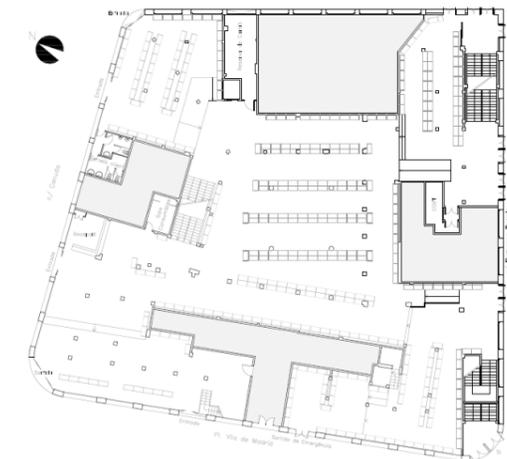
Planta Baixa. Font: Elaboració Pròpia
